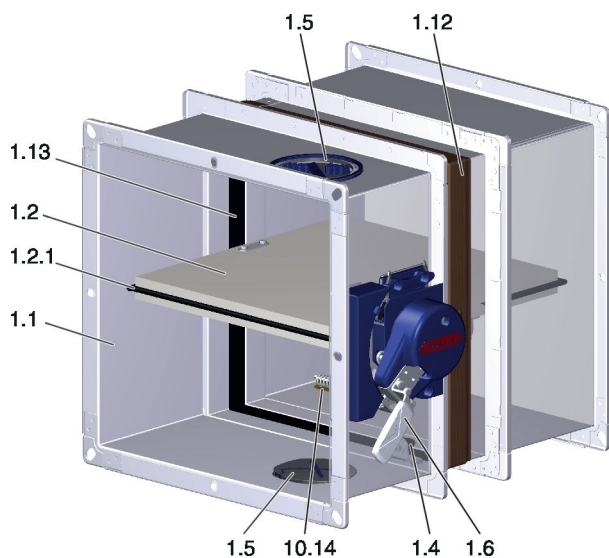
FKA2-EU med smältsäkring eller fjäderåtergångsmotor
